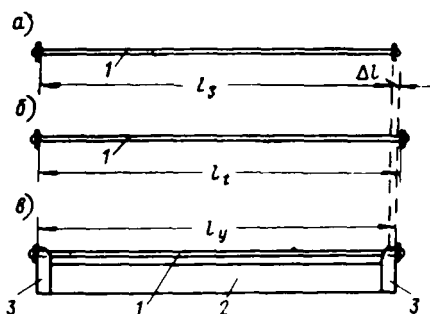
Схема натяжения стержней арматуры электротермическим способом
